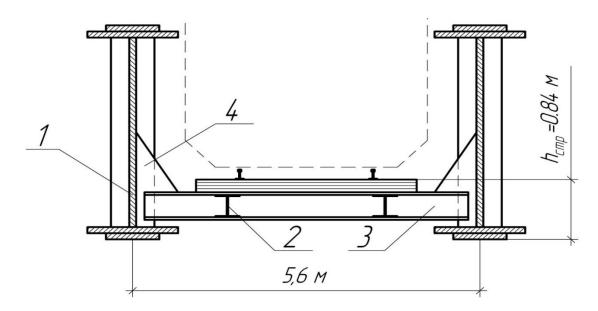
Схема поперечного сечения пролетного строения со сплошными стенками при езде понизу: 1 – лавная балка; 2 – продольная балка; 3 – поперечная балка; 4 – лист жесткости.
